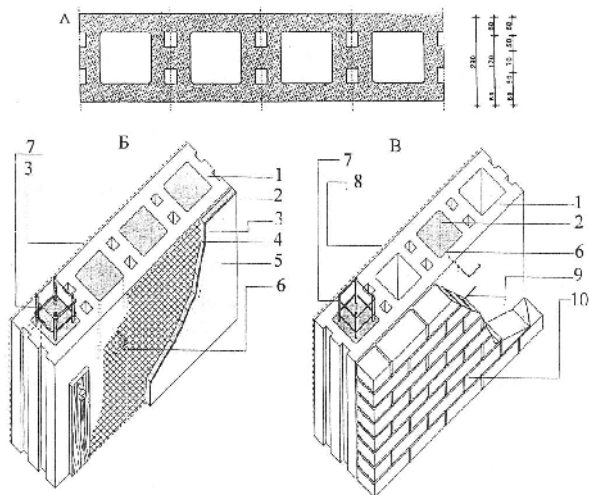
Трехлопастные наружные стены "альтернативной" конструкции: А – стеновой оставляемый пенополистирольный элемент опалубки; Б – наружная стена с мокрой штукатуркой; В – то же, с наружной кирпичной облицовкой; 1 – стеновой элемент опалубки; 2 – монолитный бетон; 3 – сетка Рабиту; 4 – штукатурке (мелкозернистый бетон); 5 – краска; 6 – анкер для сетки Рабиту; 7 – арматурный каркас; 8 – анкер для крепления облицовки; 9 – армирование кладки; 10 – лицевой кирпич
